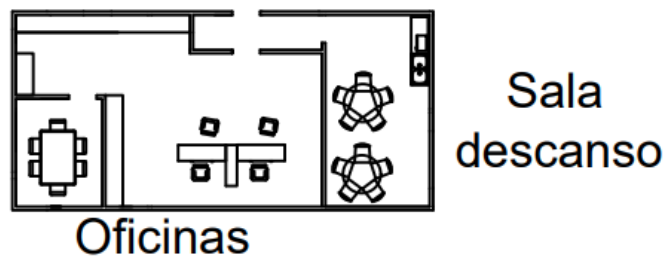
Croquis planta superior altillo secadero, propuesta 2.
